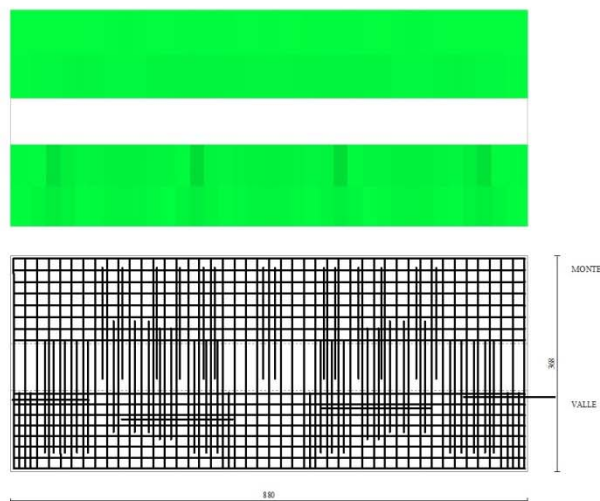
Piastra fondazione dir. X (Inviluppo)
